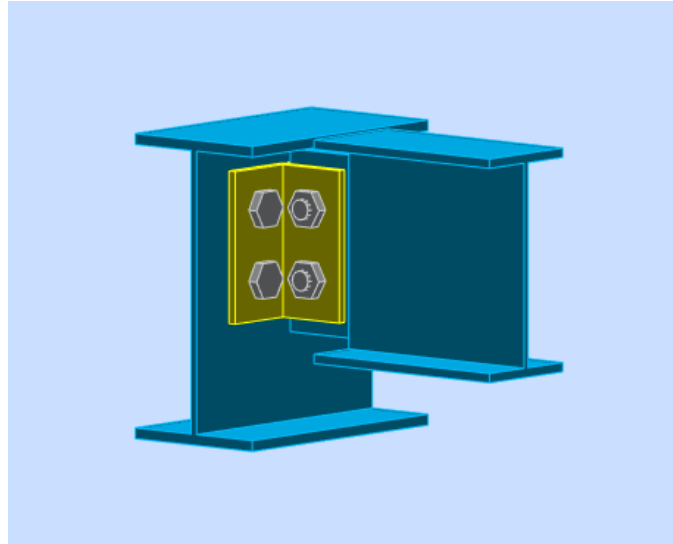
Assemblage poutre IPE300-solive IPE220.
